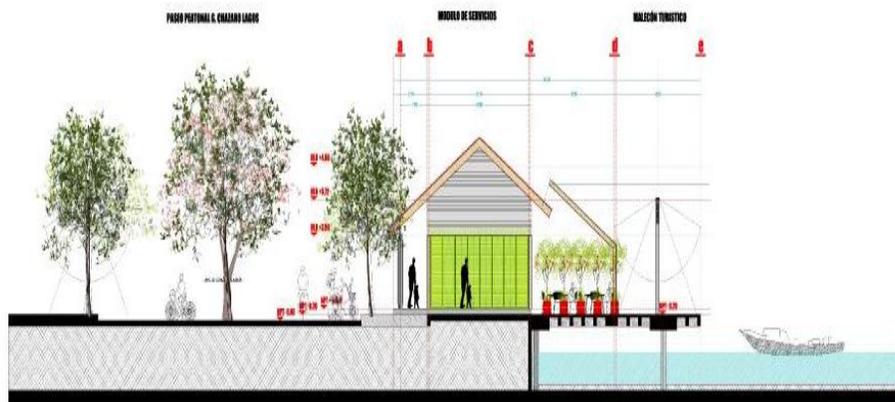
Forma de construcción de viviendas y comercios a orillas del río Papaloapan.
